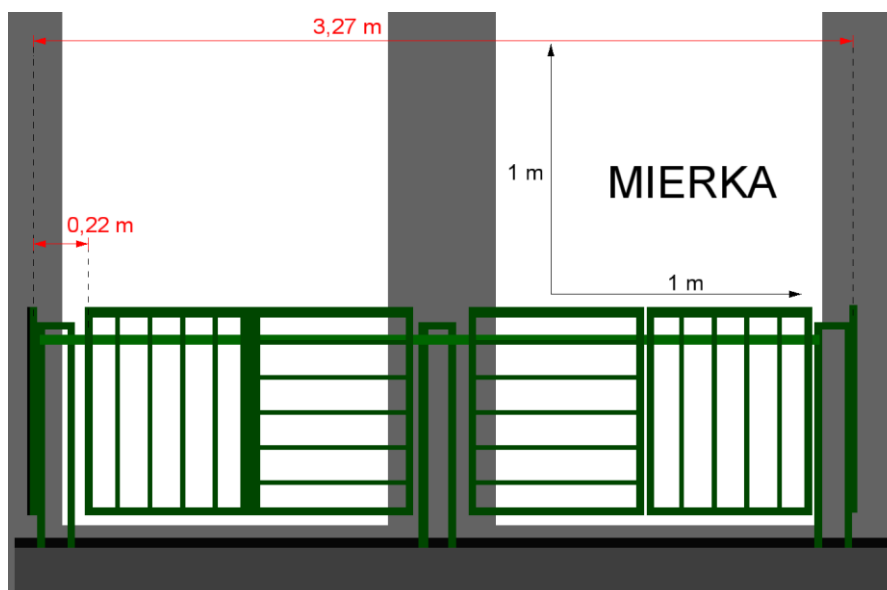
Predný pohľad na 3D CAD model predmetnej časti hotela
